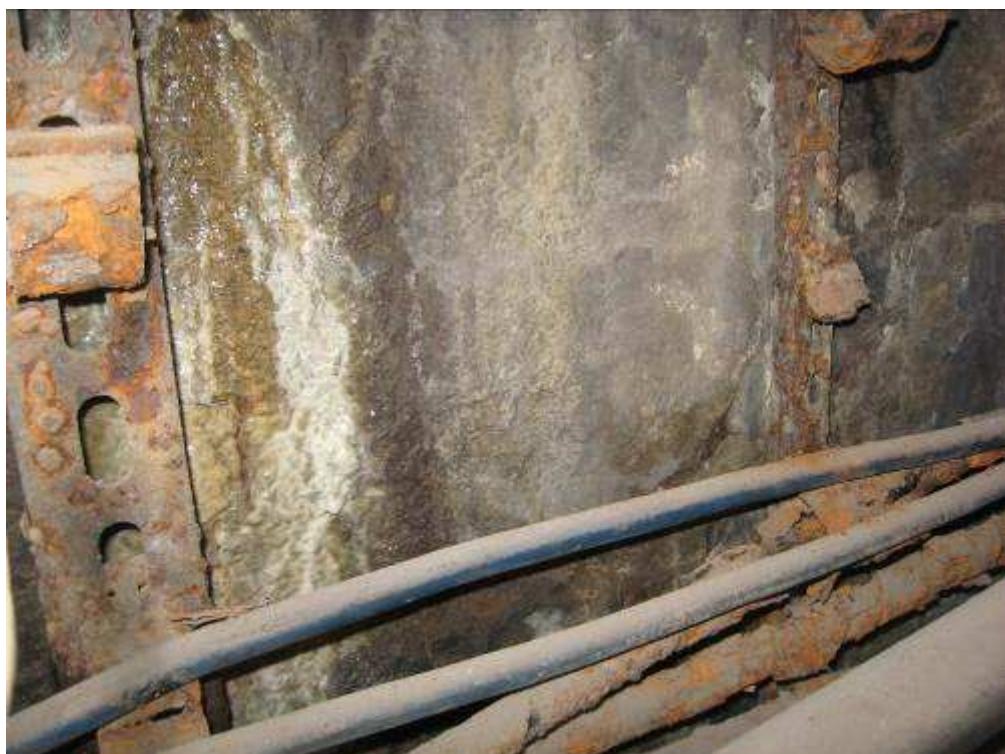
Сильное замачивание и высолы на поверхности наружных стен тоннеля в районе венткамеры ПК25
